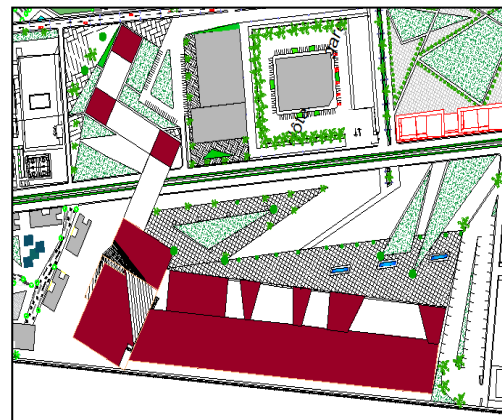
Vue en plan de la gare après l'intervention (une gare multimodale)
